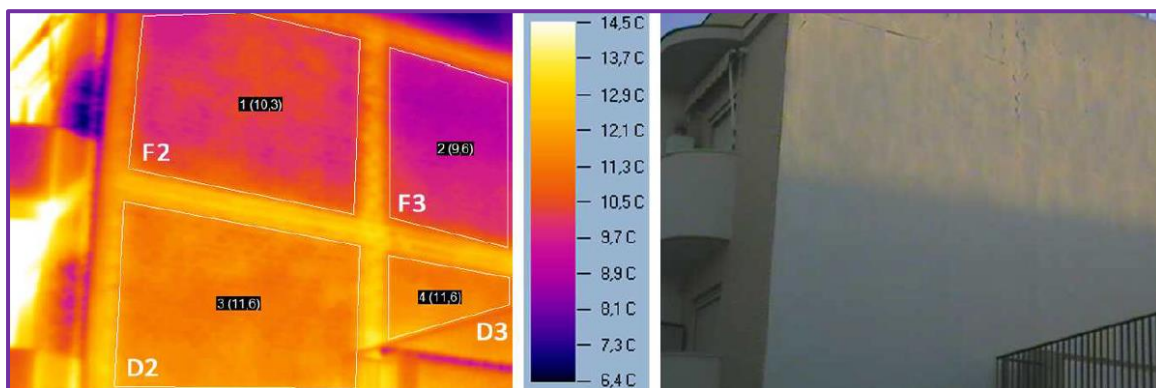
Termografía de la fachada sur (Fig. 4.30 de Facchini, 2014)
